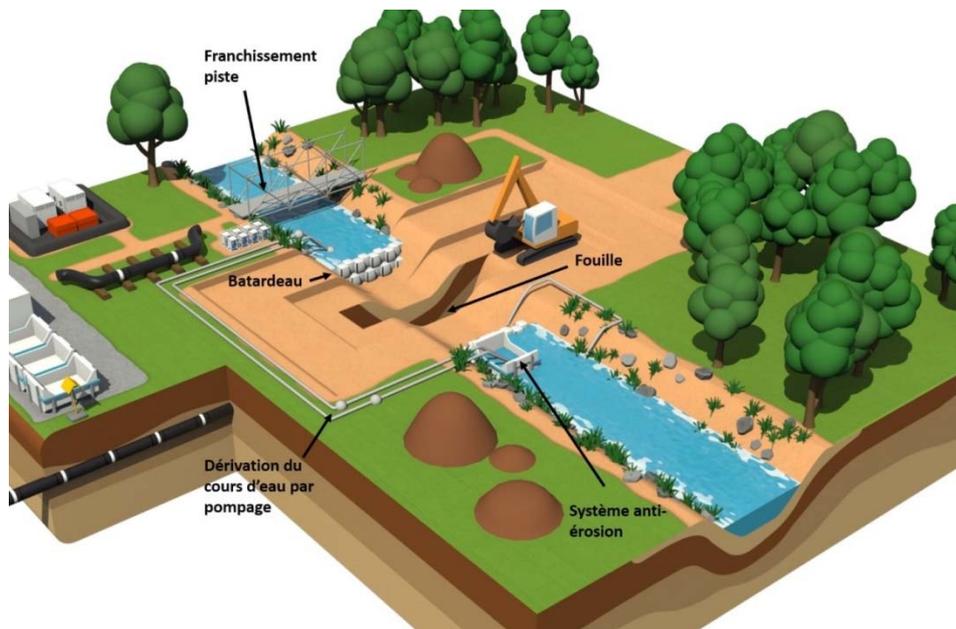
Schéma d'une traversée de cours d'eau en souille
